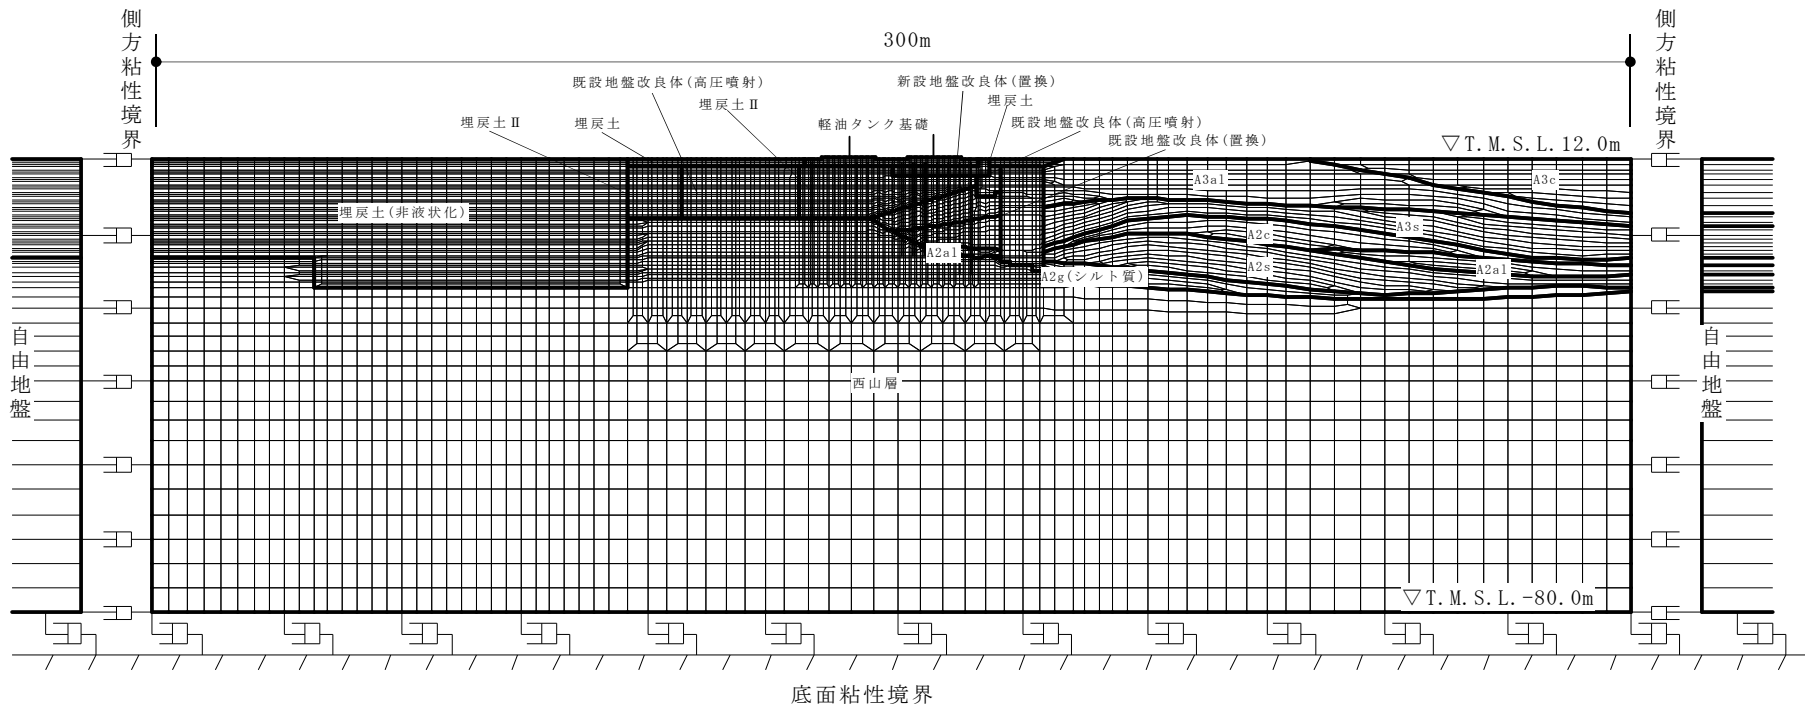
(3) 軽油タンク基礎地震応答解析モデル (EW 断面)
